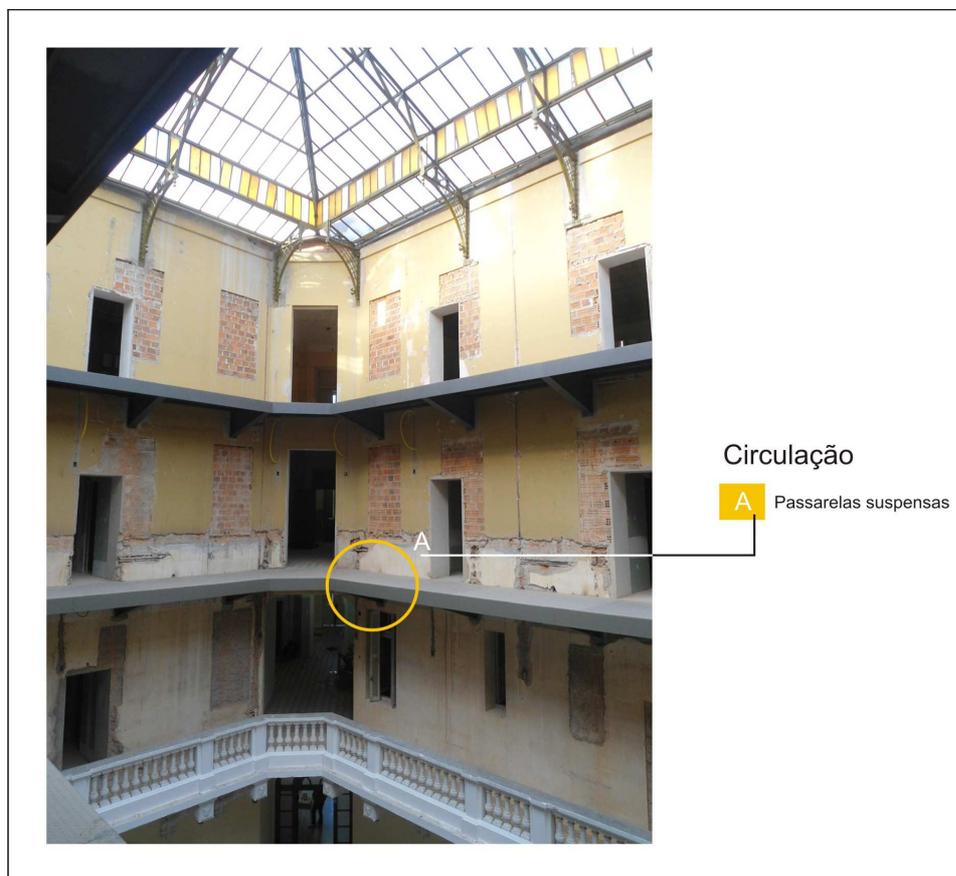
As passarelas de aço fixadas nas paredes internas criaram uma nova área de circulação para os pavimentos do segundo e terceiro andar.
